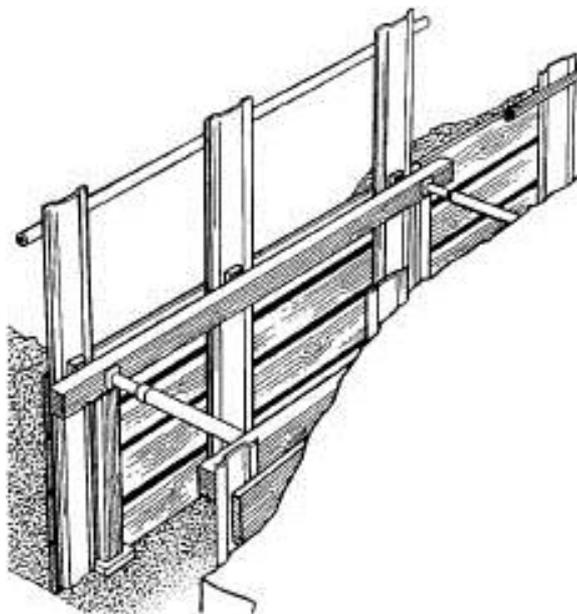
Apuntalamiento para prevenir el derrumbe de los costados de una excavación, consistente en marcos de madera o acero con entablado estrecho entre ellos.
